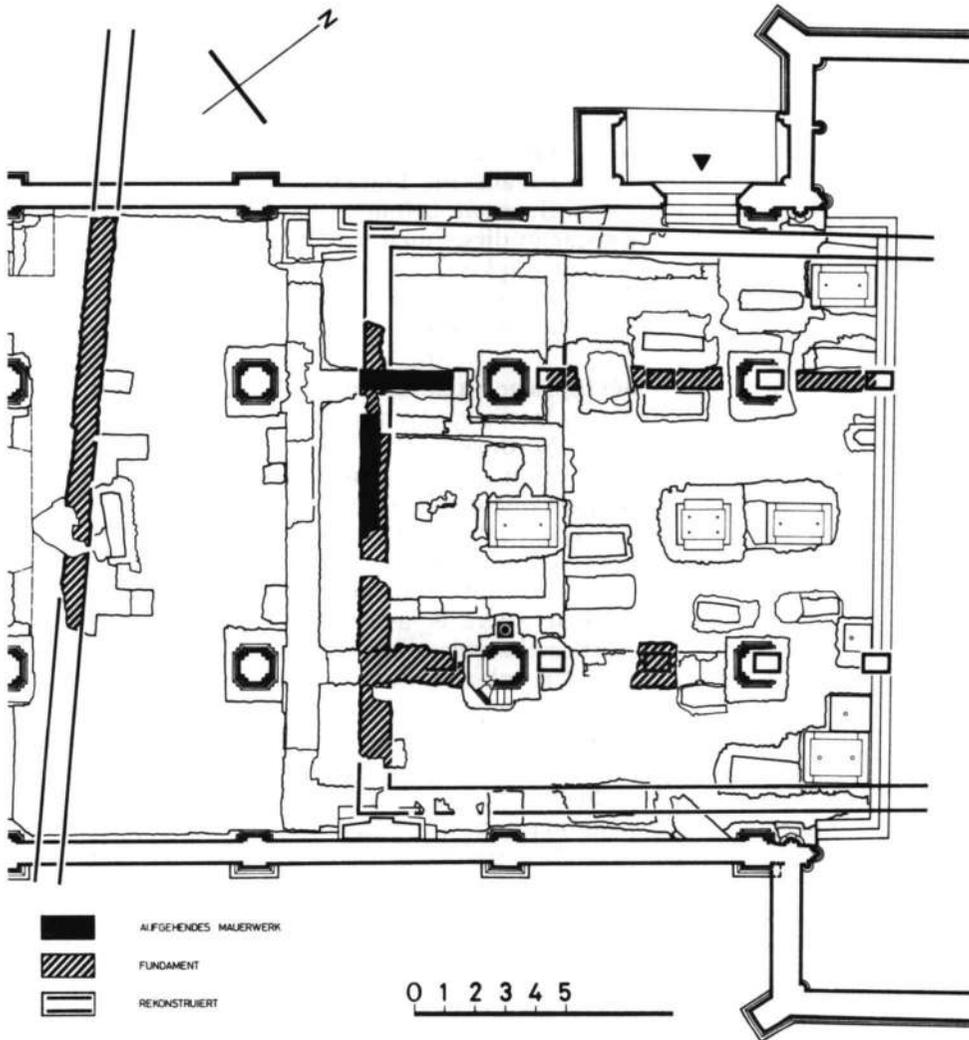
Anlage III: rekonstruierter Grundriss (Massstab 1 : 250).
